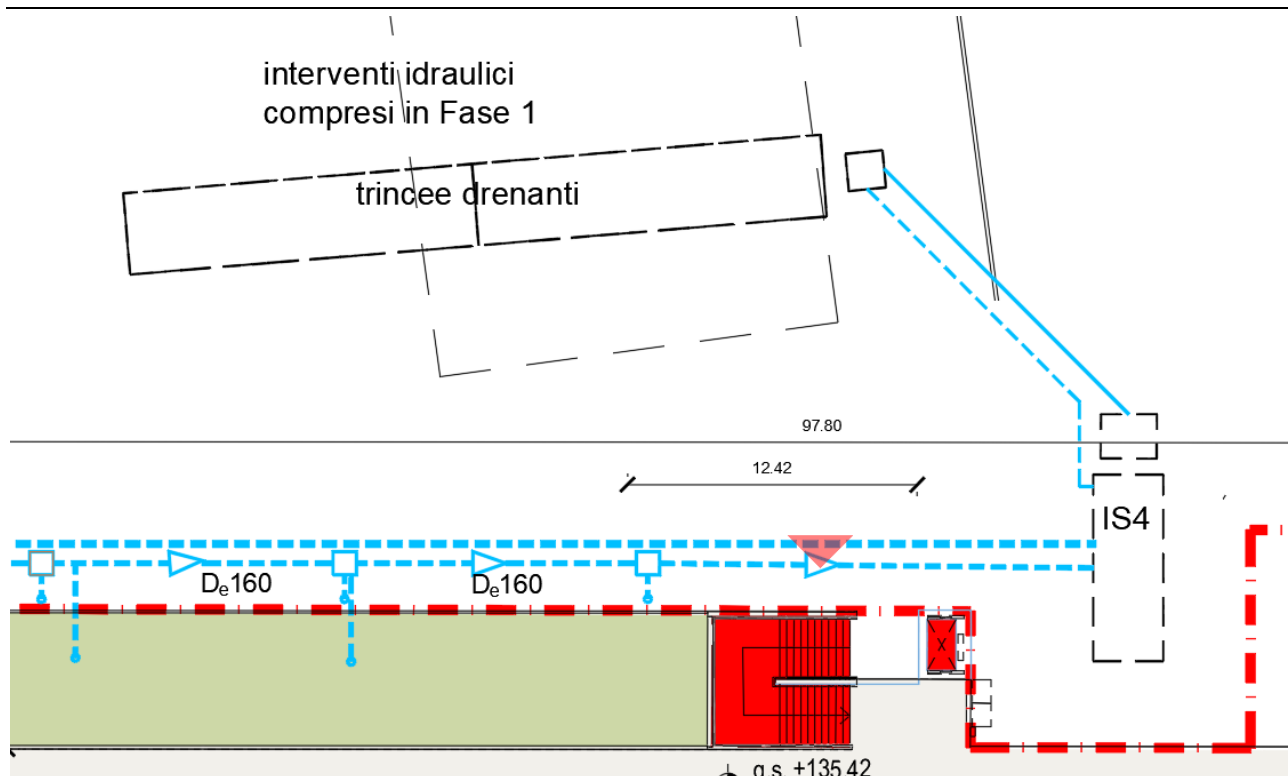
Dettaglio planimetrico della vasca di accumulo IS 4 e delle trincee drenanti
